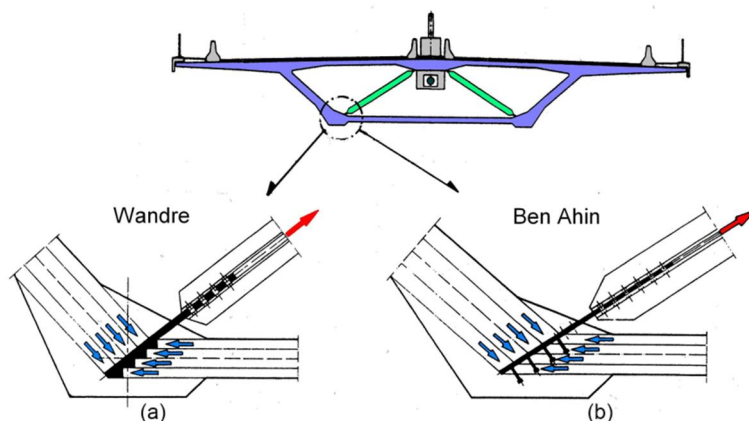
Ligações entre o caixão e as diagonais metálicas: (a) ligação através de chapas dentadas (Ponte de Wandre, Bélgica 1989) e (b) ligação através de conectores de cabeça (Ponte de Bem Ahin, Bélgica 1987). (Pedro, J.J.O., 2010).
